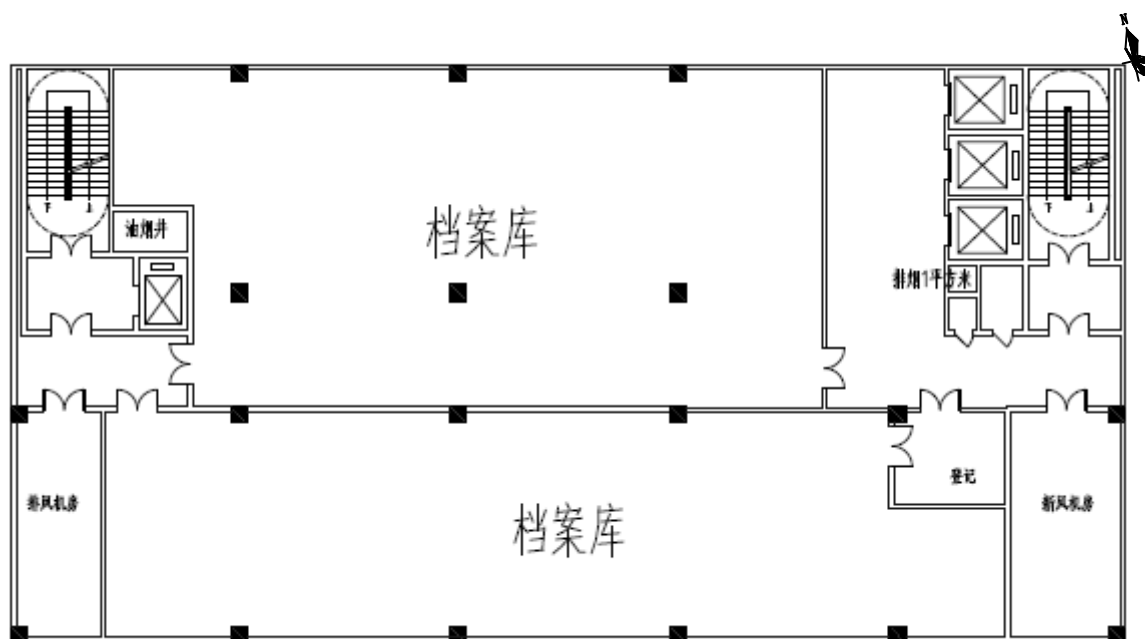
项目医疗综合楼裙楼—行政科研楼七层平面布置图 (比例尺: 1:297)
